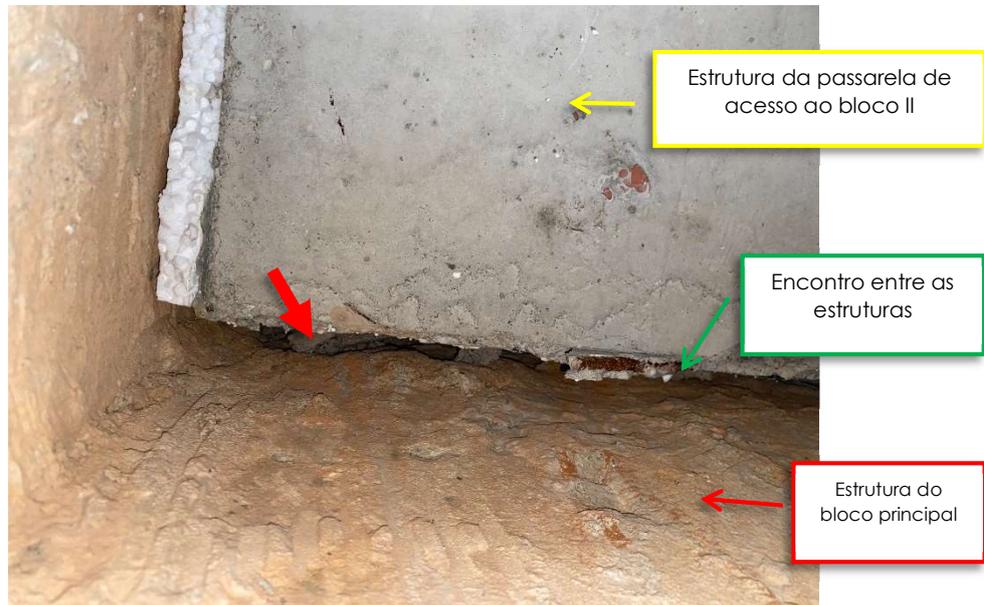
Foi constatado trechos com a falha no material de preenchimento entre as estruturas de concreto armado dos blocos, decorrente da movimentação da estrutura.
